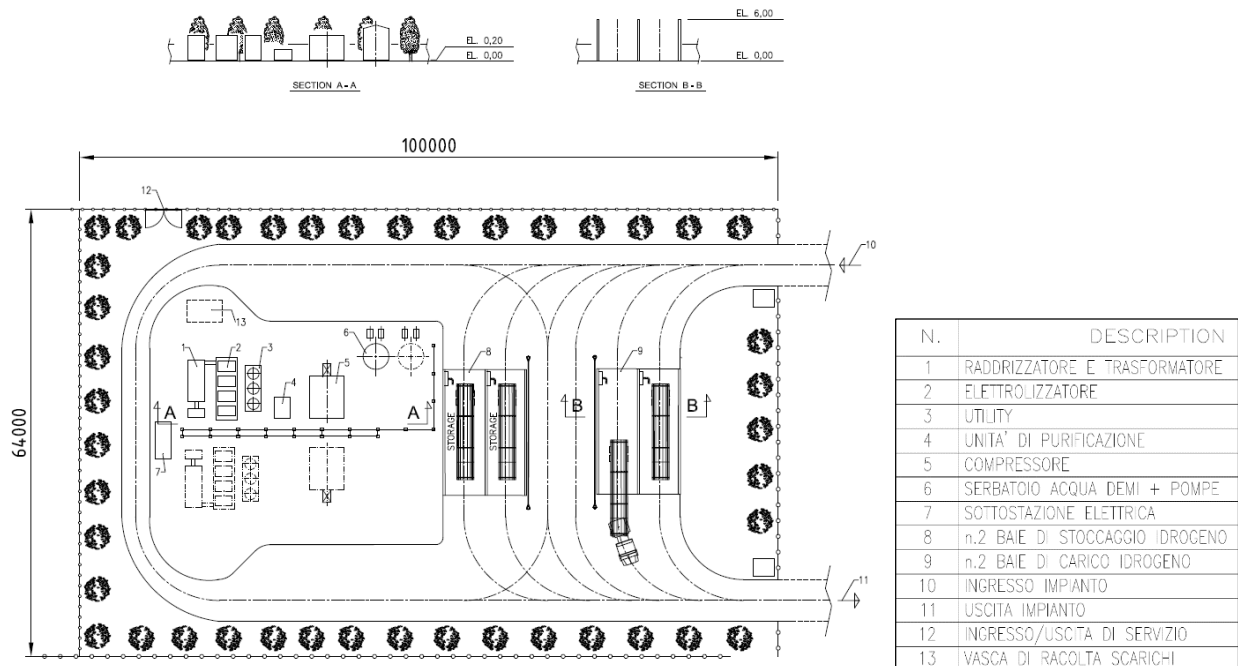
Planimetria preliminare dell’Impianto di Idrogeno Verde
